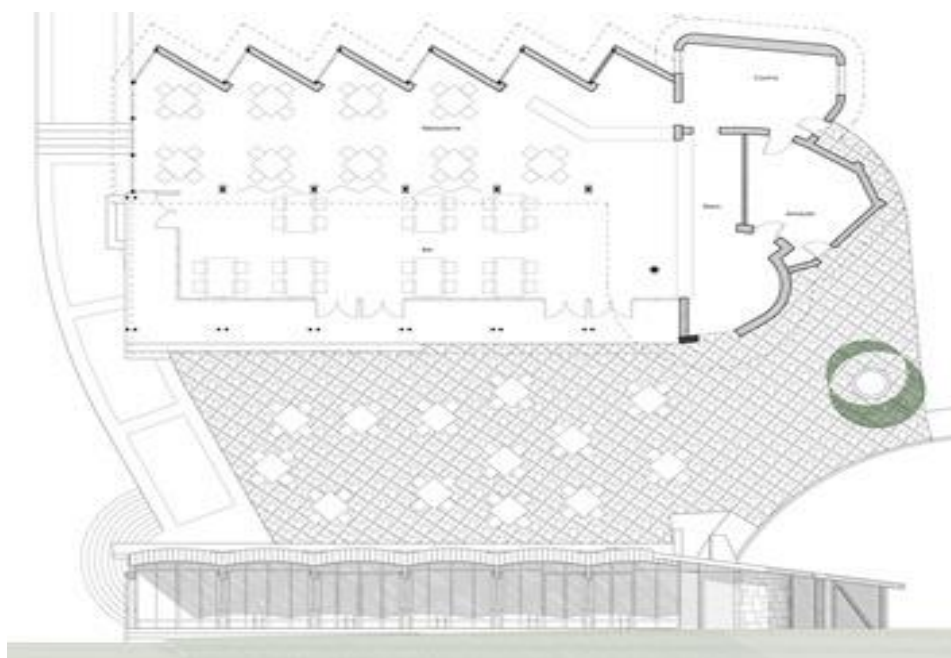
; Planta y alzado de estado actual del Bar-Merendero y la plaza. Fuente: <https://unfuturoparaperlora.blogspot.com/>
